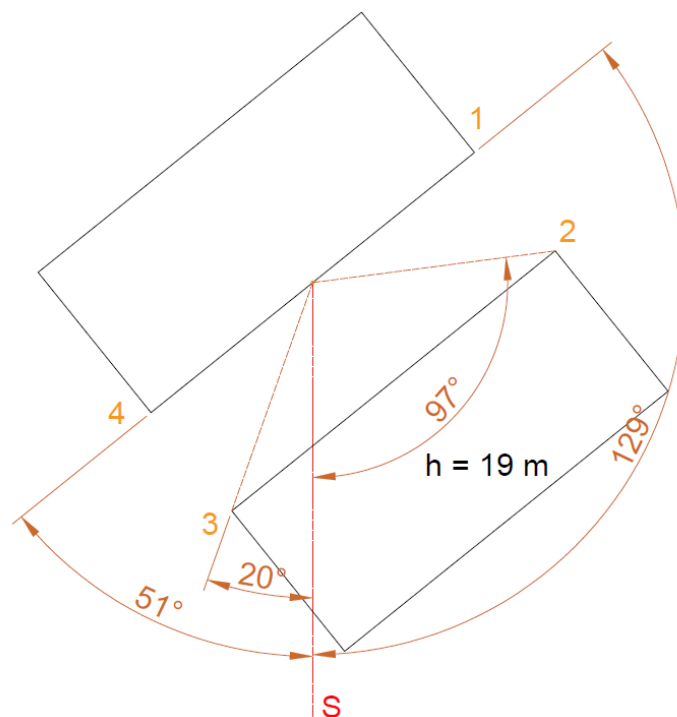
Esquema para cálculo de sombras en la fachada sureste.
